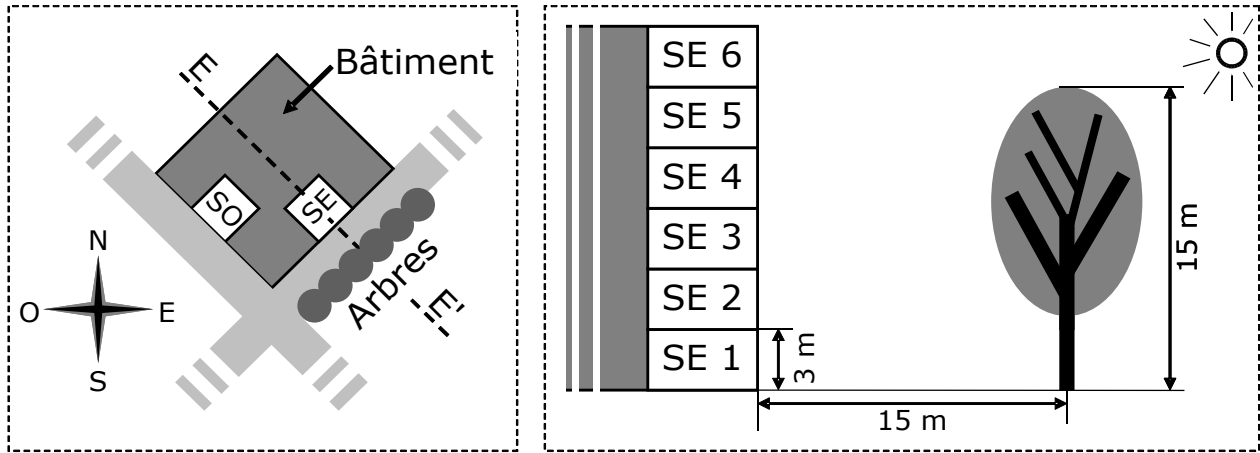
Vue en plan du bâtiment (à gauche) et coupe EE' (à droite)
